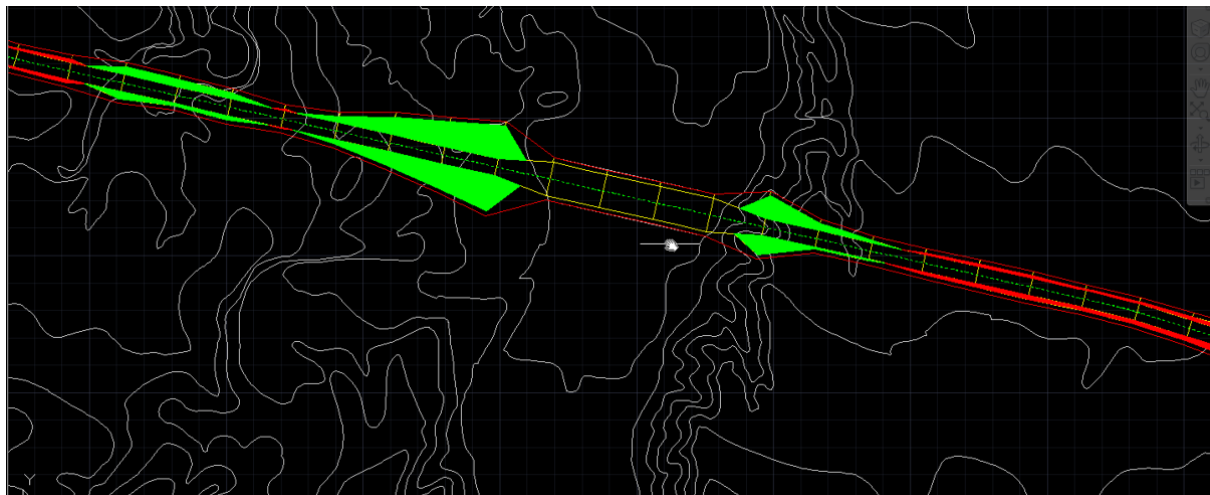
Detalle de planta de un puente salvando una vaguada.
